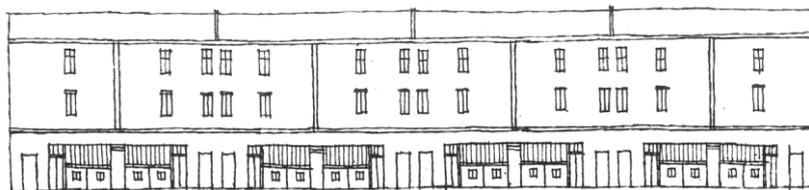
El pasaje Pierre loti del cerro Concepción da cuenta del traslado de la tipología del terrace house inglesa a Valparaíso y de las técnicas del montaje en seco.
